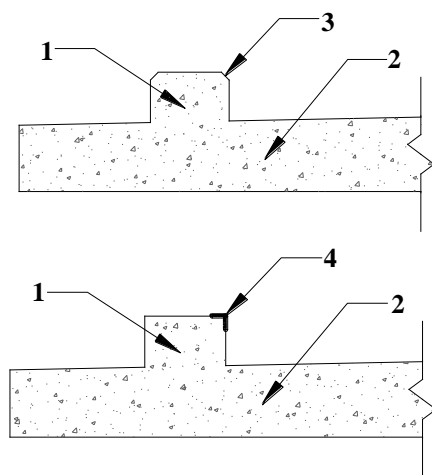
Apoios com elementos de betão armado no topo do tabuleiro.
